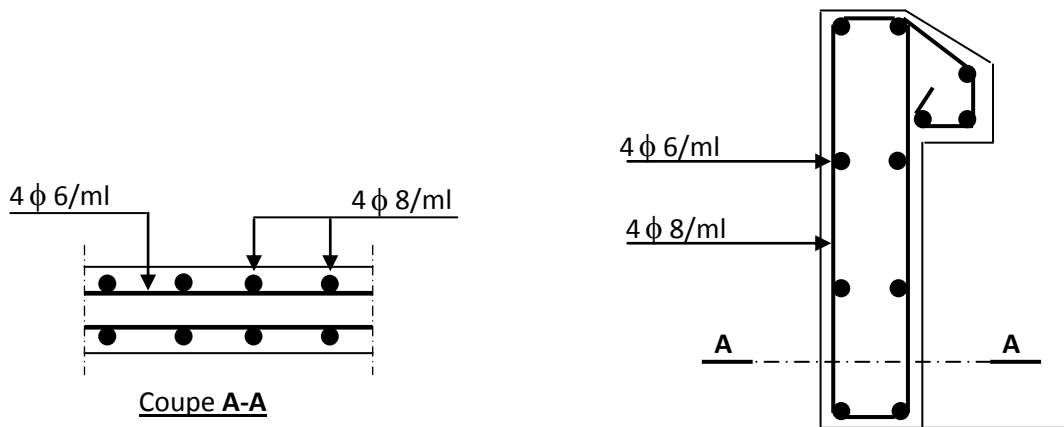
Schéma de ferrailage de l'acrotère.
